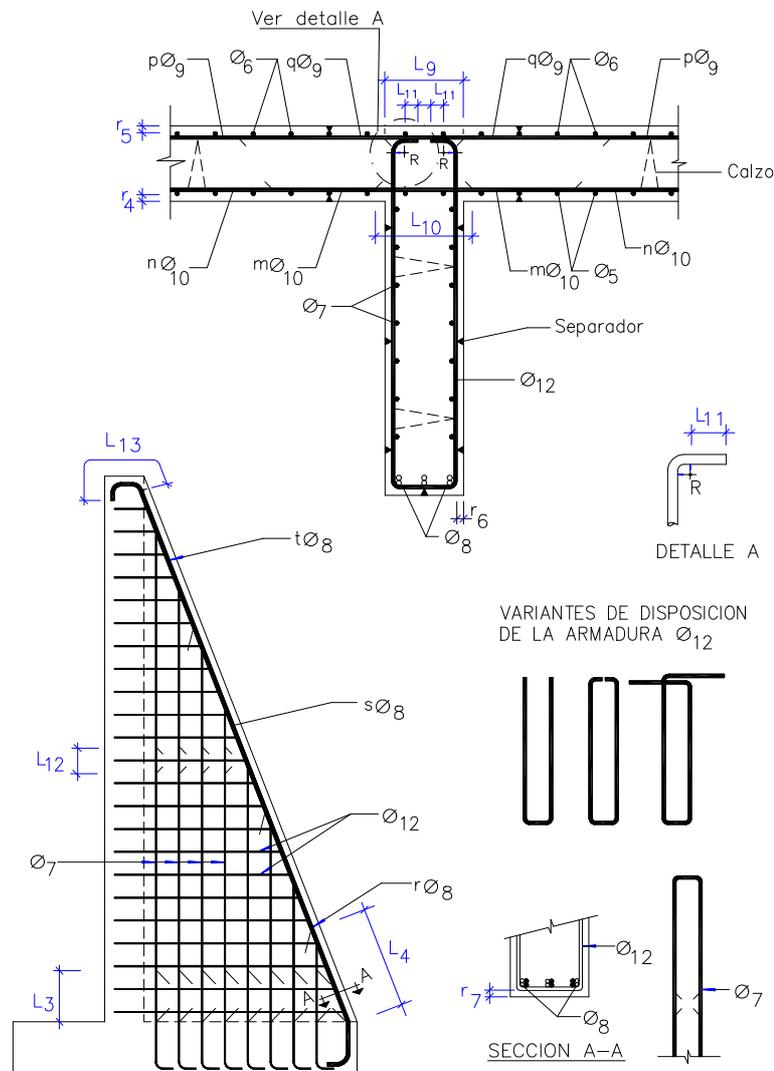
Muros de contrafuertes (contrafuerte intermedio)
